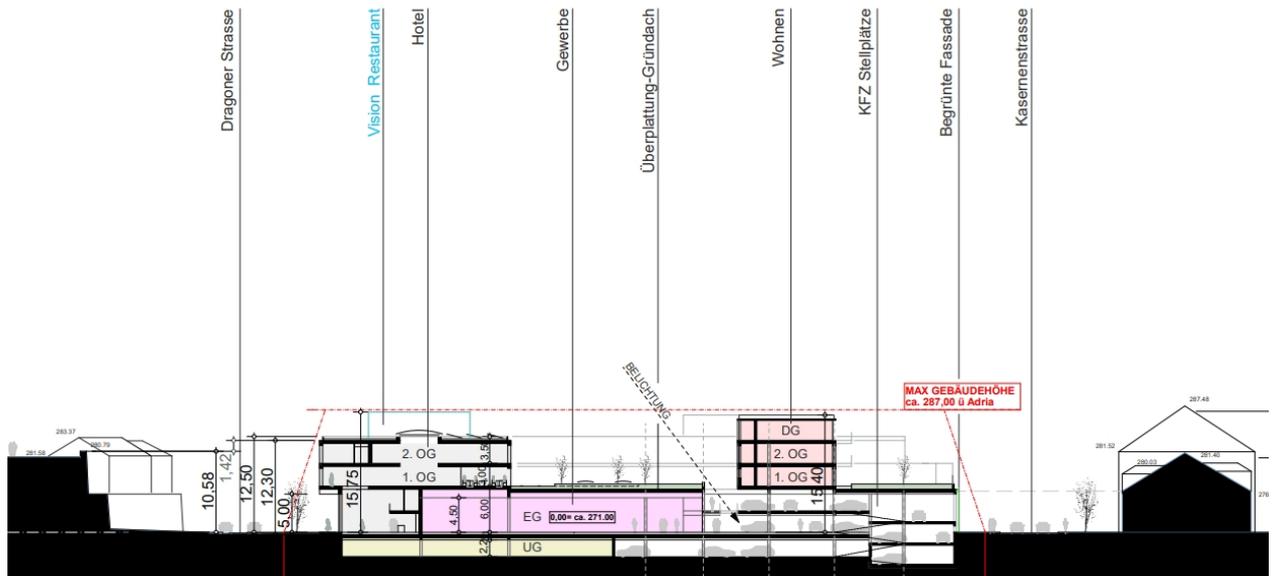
Schnitt der geplanten Gebäude mit Darstellung der Geschöße und Bezugshöhe, Neuhauser, 26.07.2022
